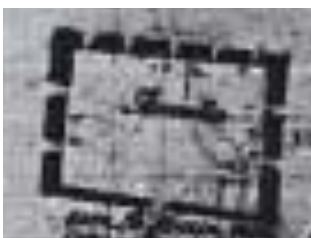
Primer levantamiento del Fuerte datado en 1730-40.
